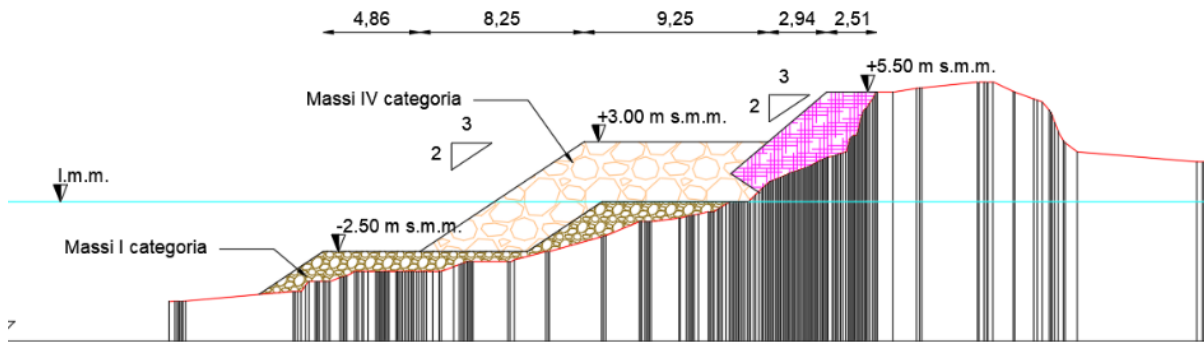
Sezione tipo del tratto compreso fra la sezione 5 e la sezione 7
